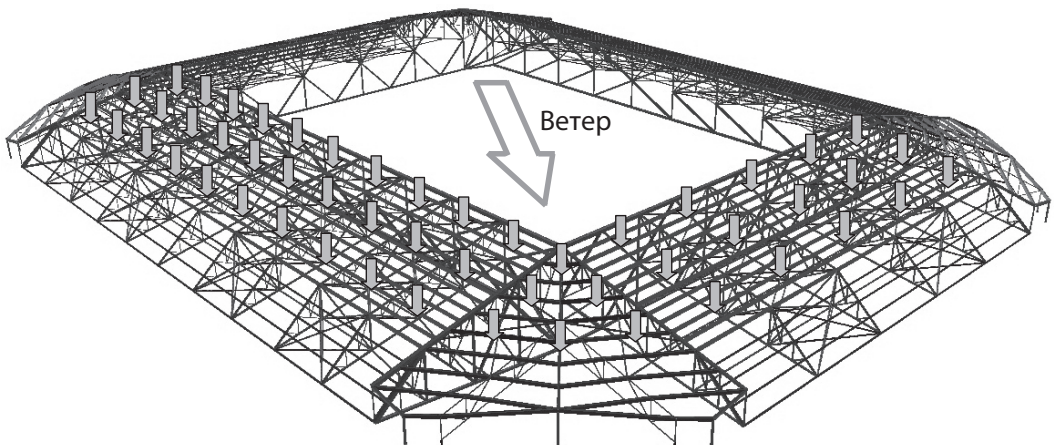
Компьютерная модель металлического покрытия стадиона с дополнительной снеговой нагрузкой (колонны условно не показаны)
